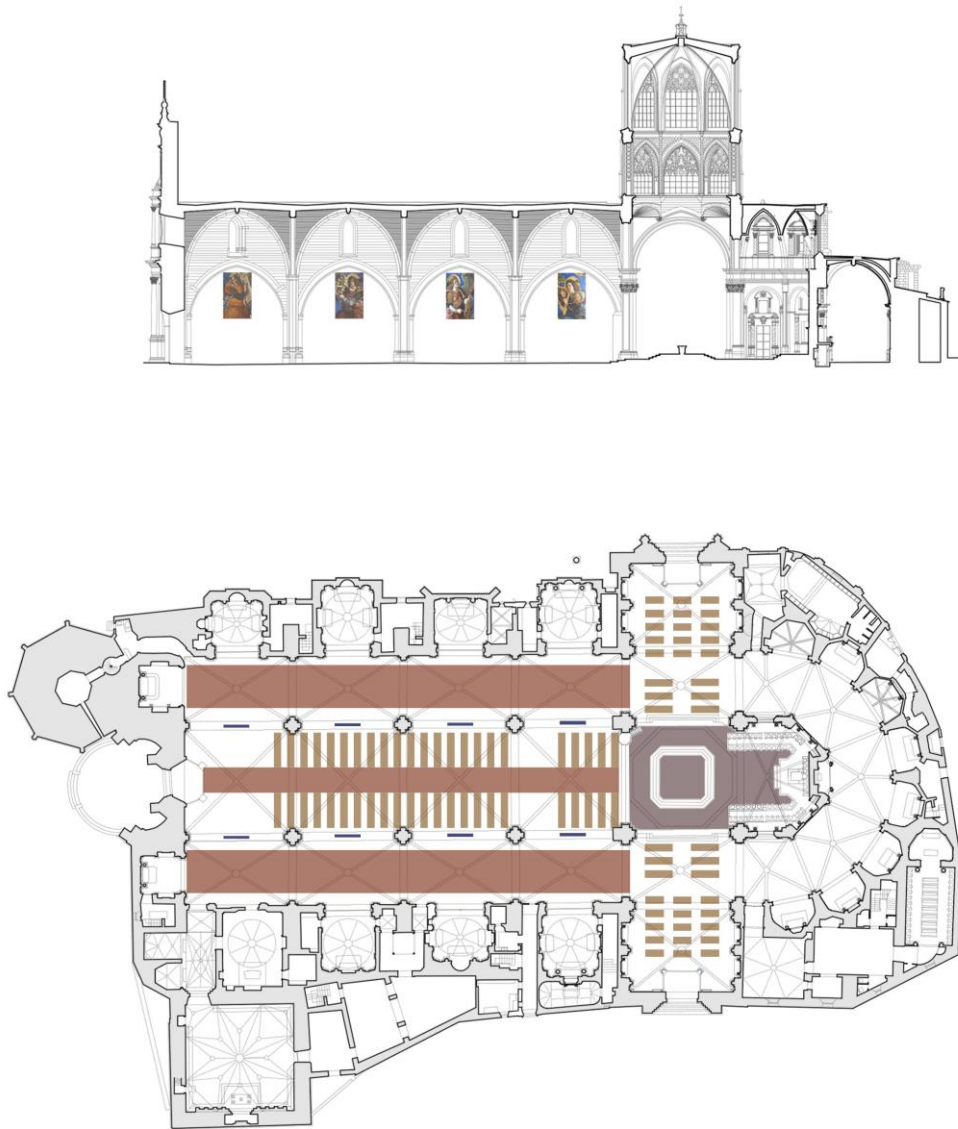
Ubicación en planta y alzado de los elementos textiles decorativos en la mejora del acondicionamiento acústico para la palabra (mejora B).
